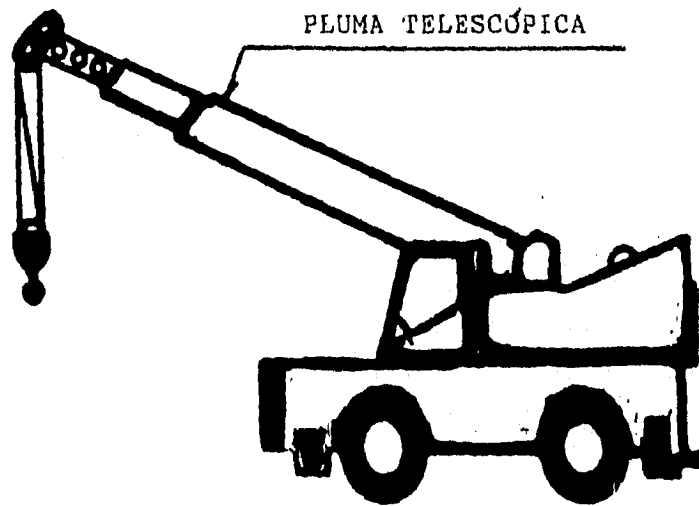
GRÚA MOVIL DE PLUMA TELESCÓPICA (PATO)
